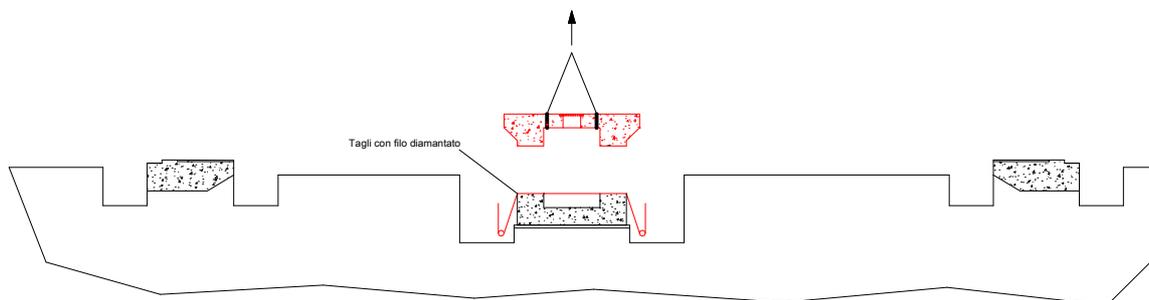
taglio e rimozione sezioni periferiche e struttura centrale fondazione
